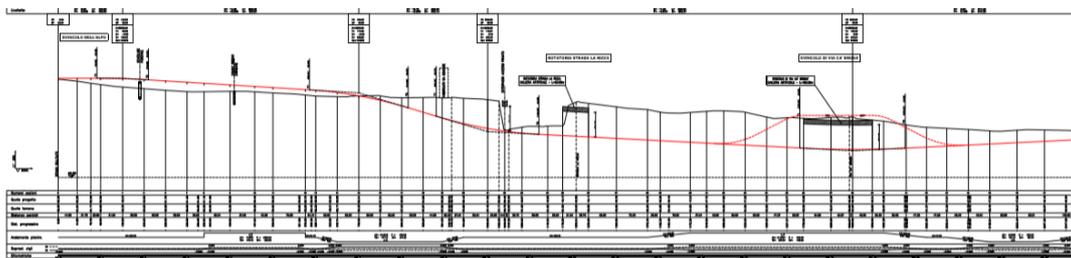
Tratto Svincolo di Verona Sud - Svincolo di Via Cà Brusà- Planimetria e Profilo longitudinale
